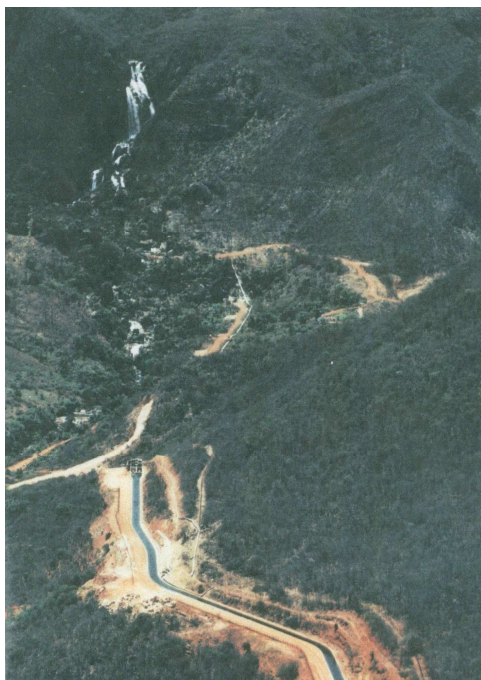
Cachoeira do Brumado e Canal de Irrigação do Perímetro Irrigado do Brumado
